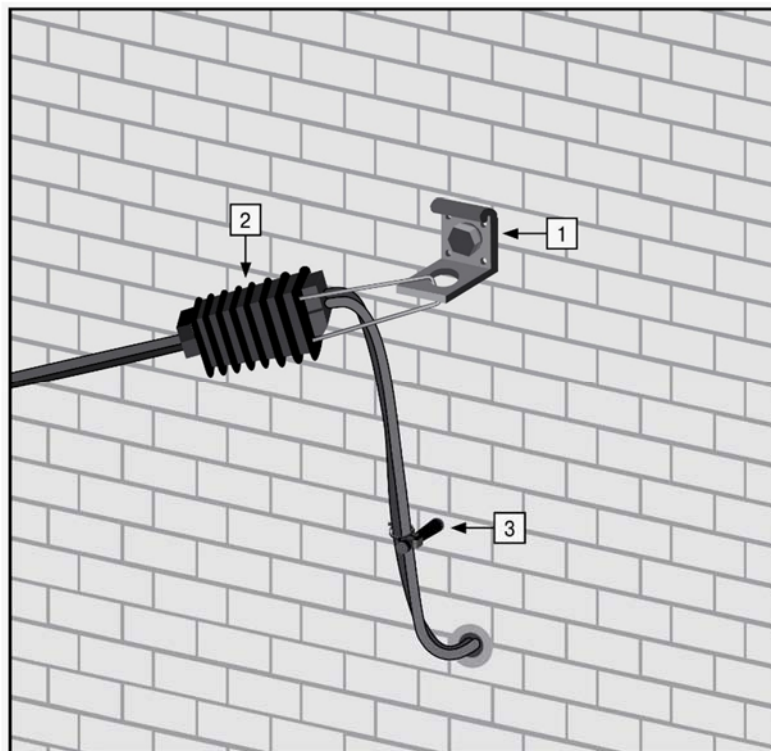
Анкерное и промежуточное крепление СИП абонентского ответвления на стенах зданий
